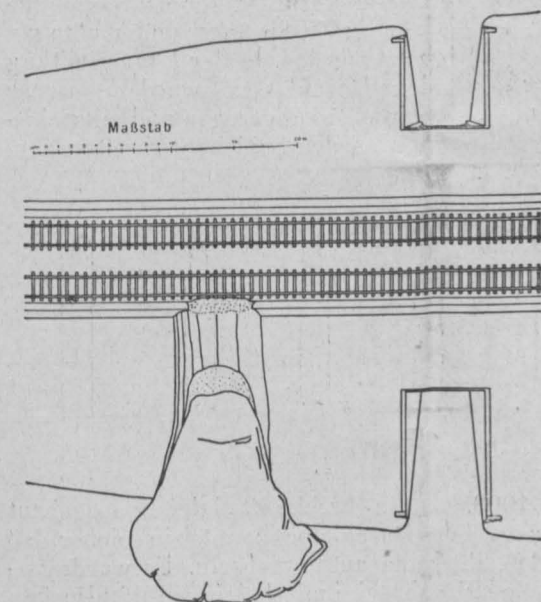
Dammrutschung auf ruhigem Boden, Draufsicht
